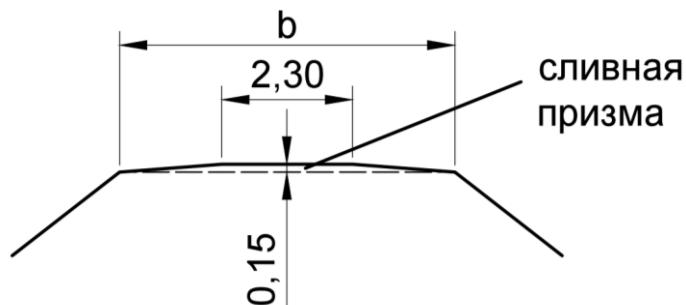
Поперечное очертание основной площадки земляного полотна на прямых участках
